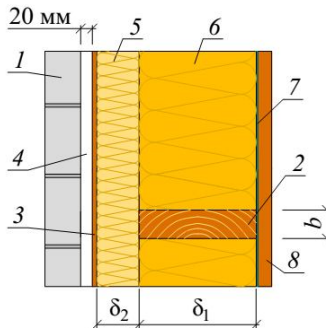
Конструкция наружной стены с внешним слоем кирпичной кладки: 1 – кирпич; 2 – рейка (шаг 0,6 м); 3 – обшивка; 4 – 20 мм вентилируемого слоя; 5 – наружный слой тепловой изоляции; 6 – внутренний слой тепловой изоляции; 7 – пароизоляция; 8 – внутренняя облицовка
